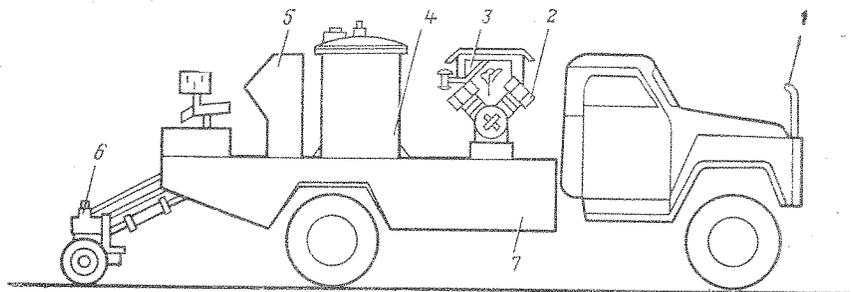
Общий вид маркировочной машины ДЭ-18:
